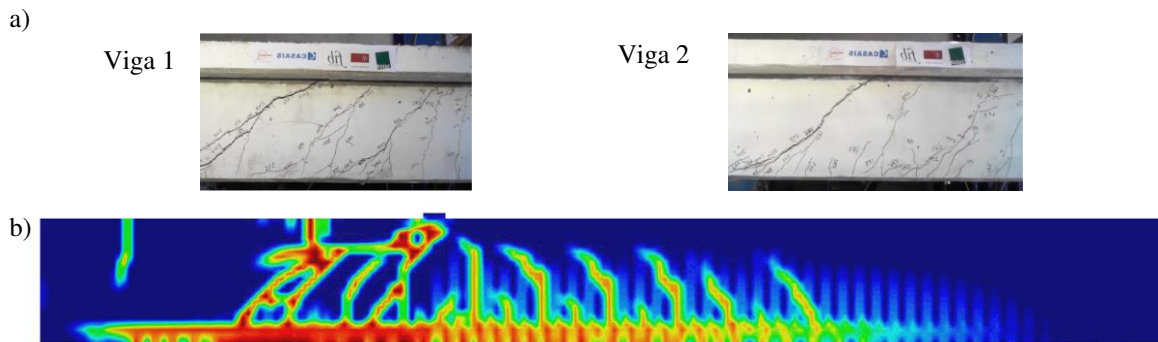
Daño. a) Fisuras en las vigas ensayadas ([Barros et al. 2020](#)) ; b) Variable de daño plástico (numérico)
